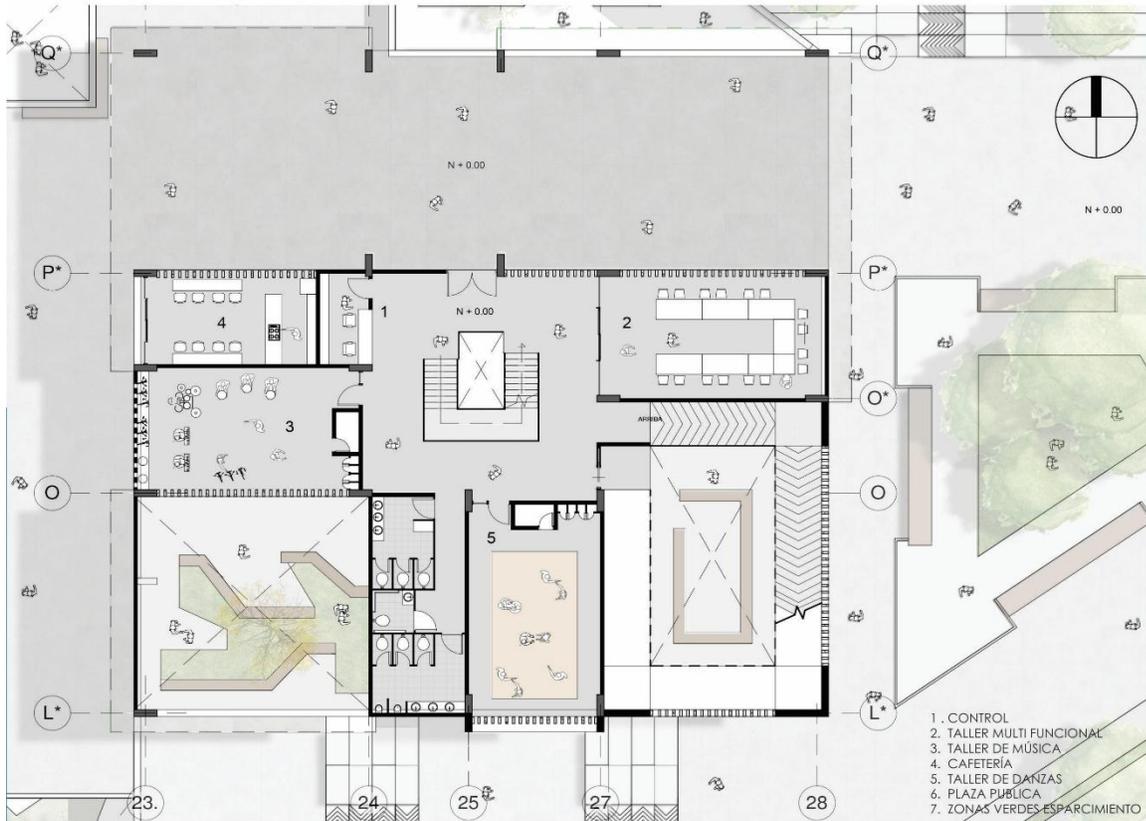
Planimetría plaza y salones de talleres nivel + 0.00
